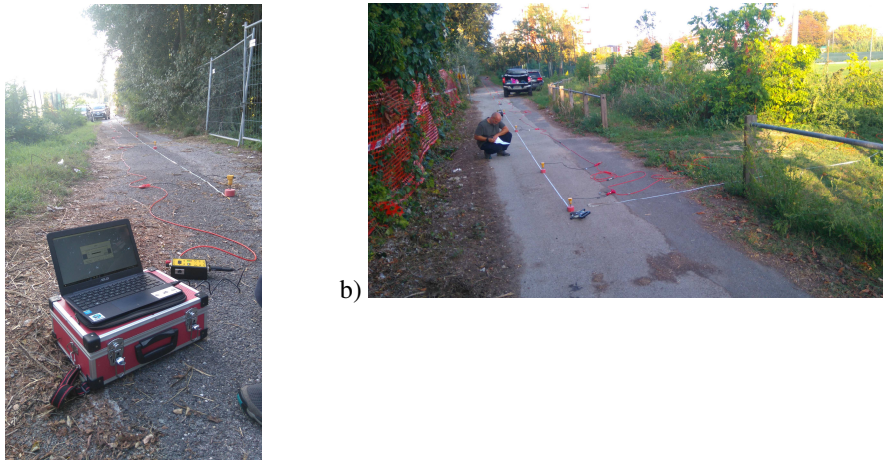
(a) Acquisizione ed elaborazione dati; b) schema geometrico esecutivo della prova.
